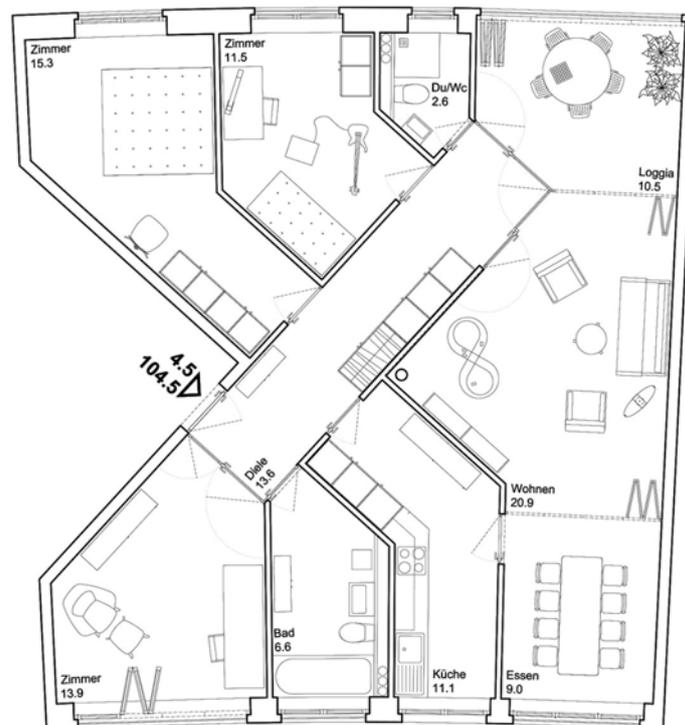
Wohnungsgrundriss 4.5 Zimmer - Whg.
